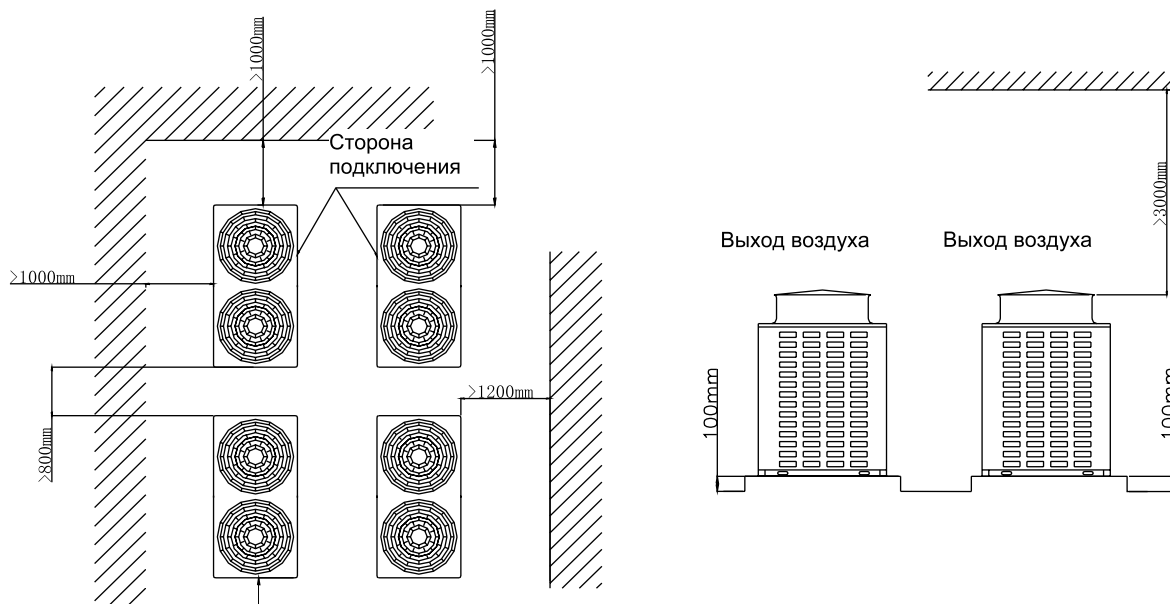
Требования по размещению группы наружных блоков с выпуском воздуха сверху
